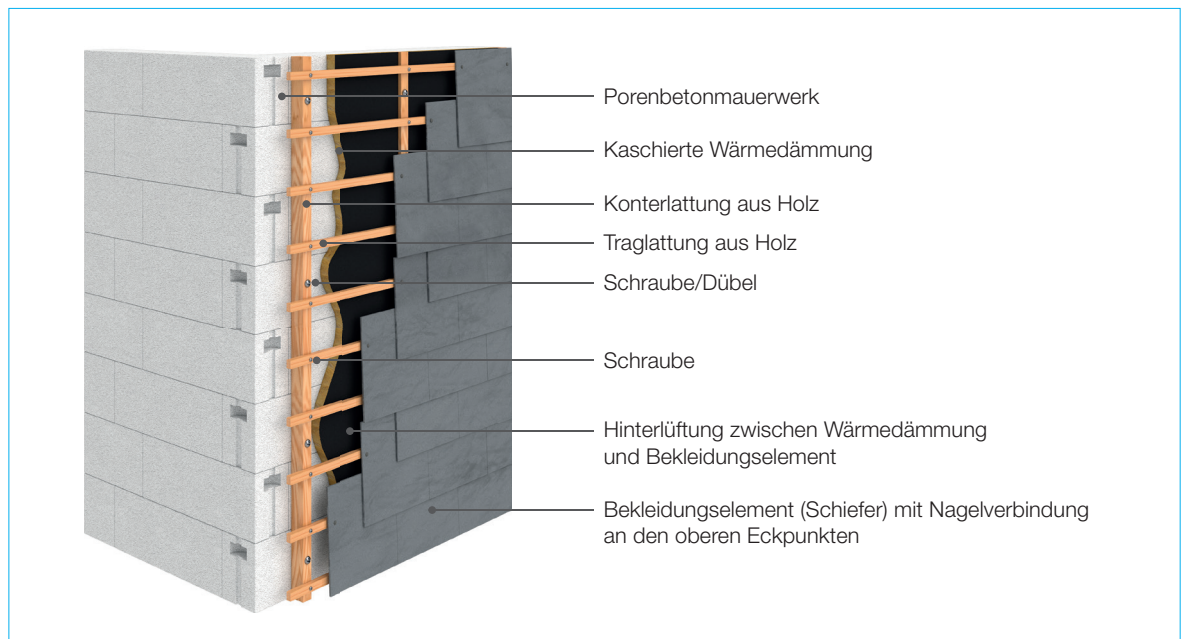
Hinterlüftete Außenwandbekleidung auf Porenbetonmauerwerk – beispielhaftes Konstruktionsprinzip mit Holzunterkonstruktion aus Trag- und Konterlattung
